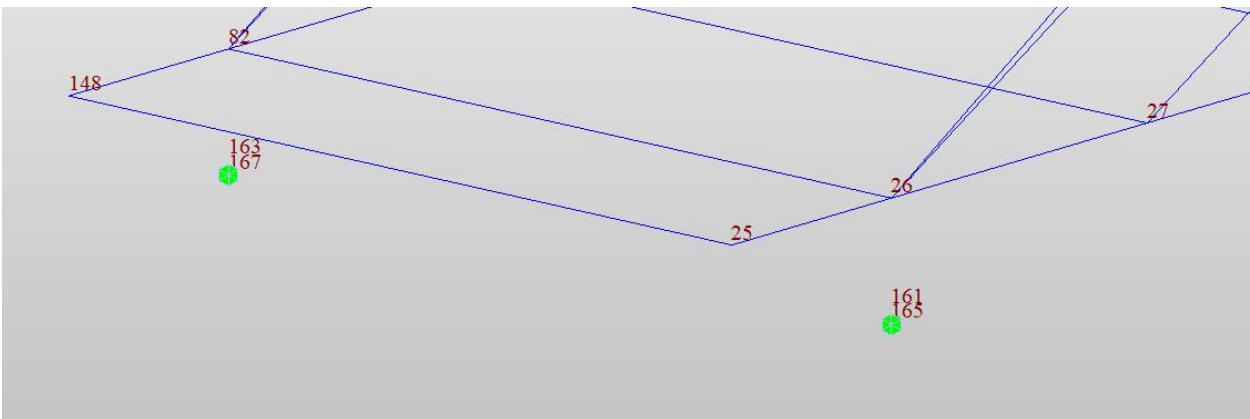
Empotramientos apoyos con estribos
